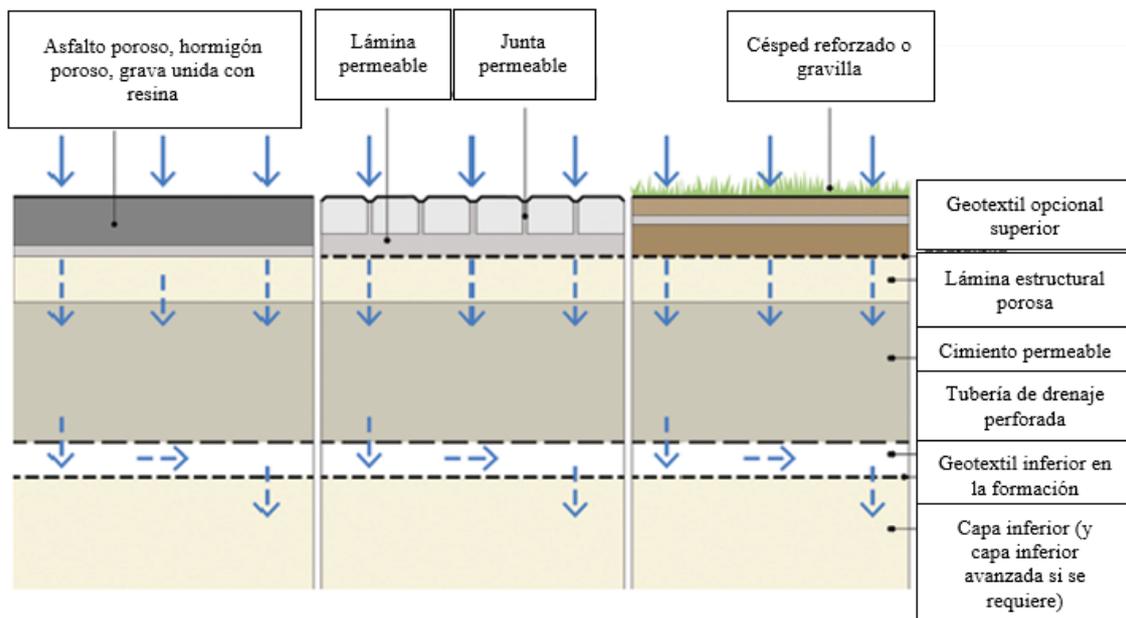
Esquema de los sistemas de pavimentos permeables Tipo B. (19)
